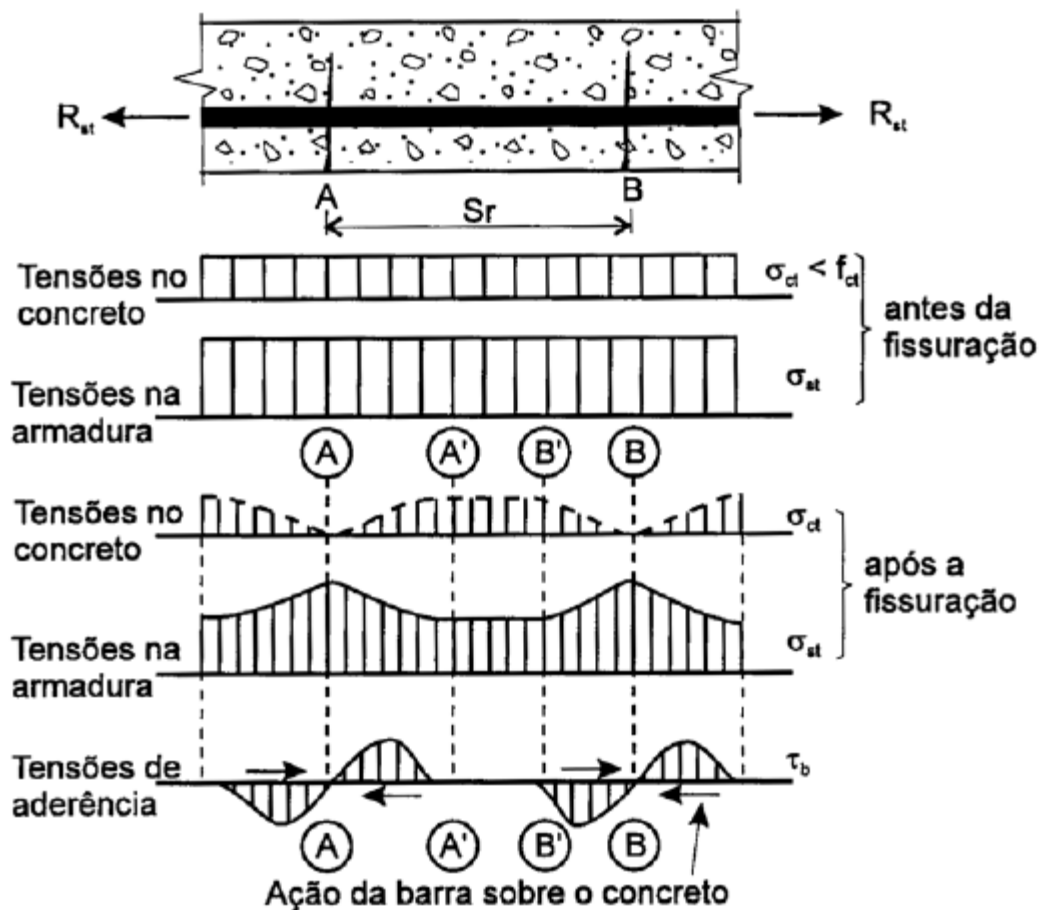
Fissuração por tração (FUSCO, 1995)
